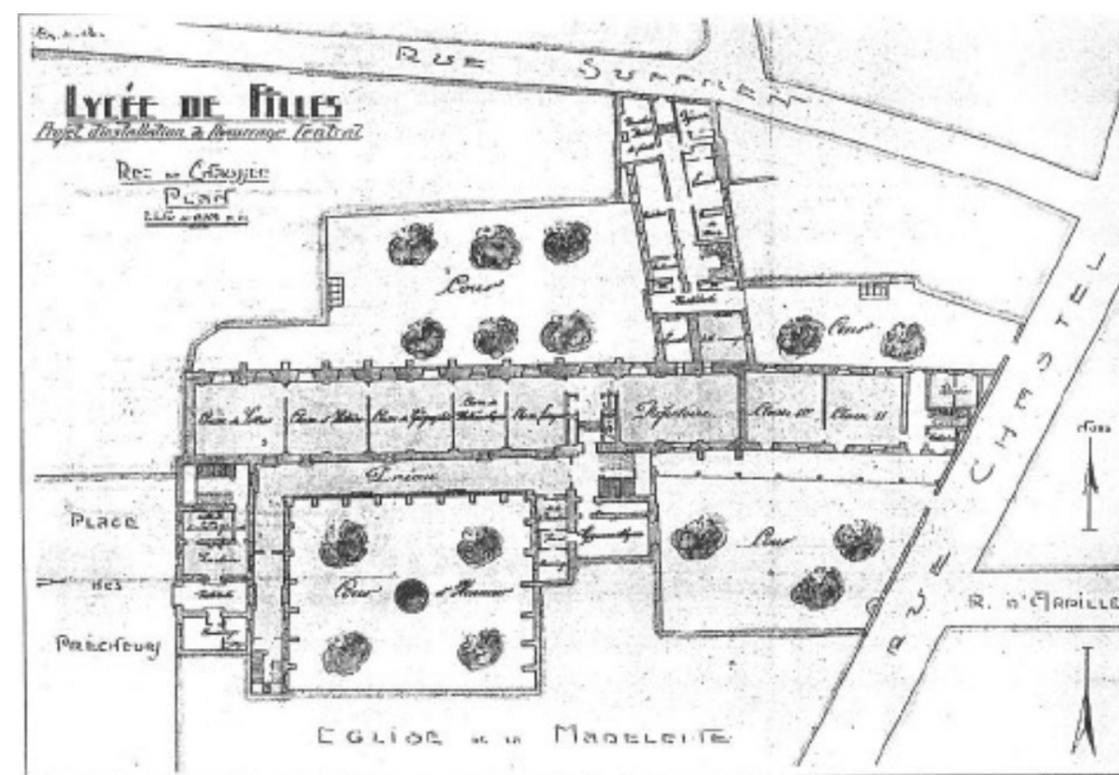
Plan du rez-de-chaussée du lycée de jeunes filles, octobre 1929 (ADBDR III° 2/40)
